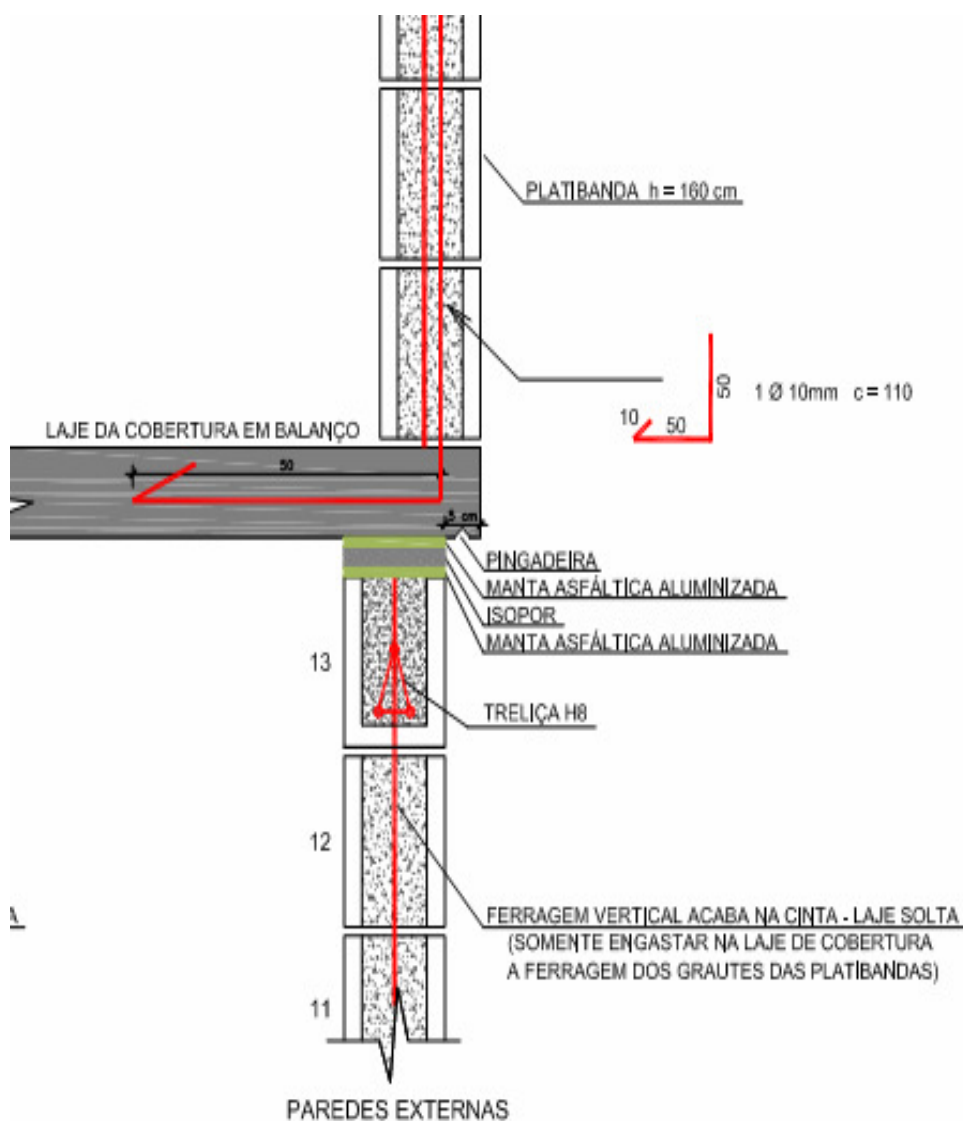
detalhe do apoio das lajes maciças em paredes externas
